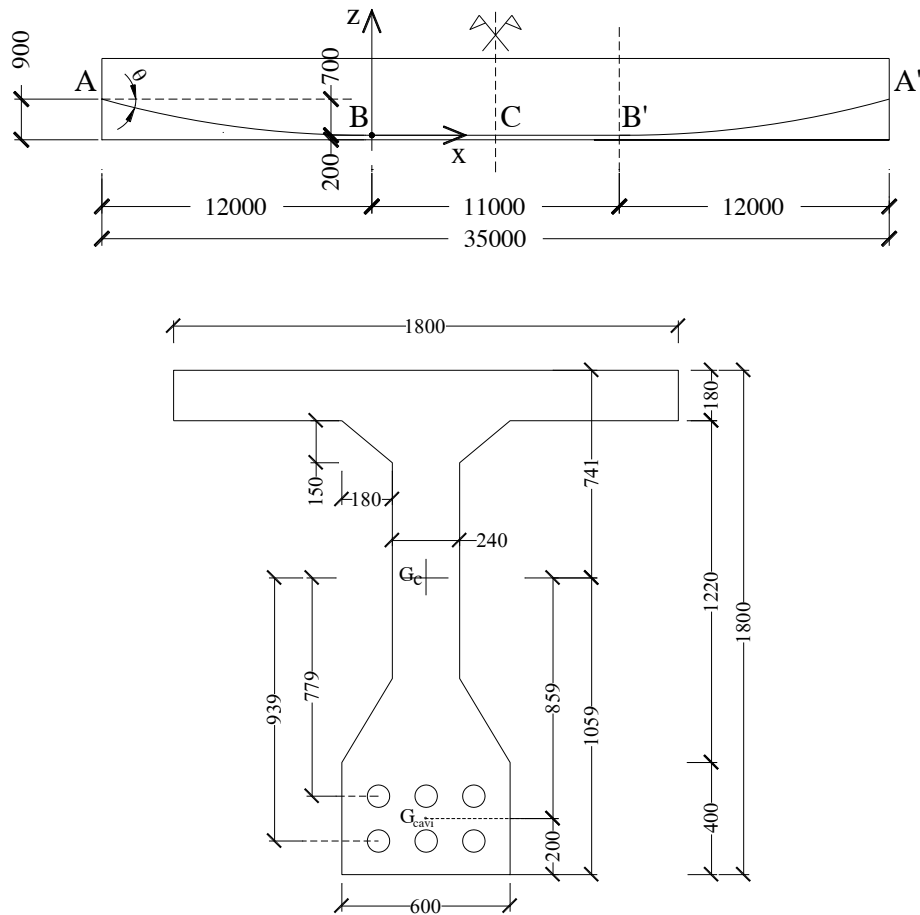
Sezione longitudinale e trasversale di trave con armature post-tese (quote in mm).
